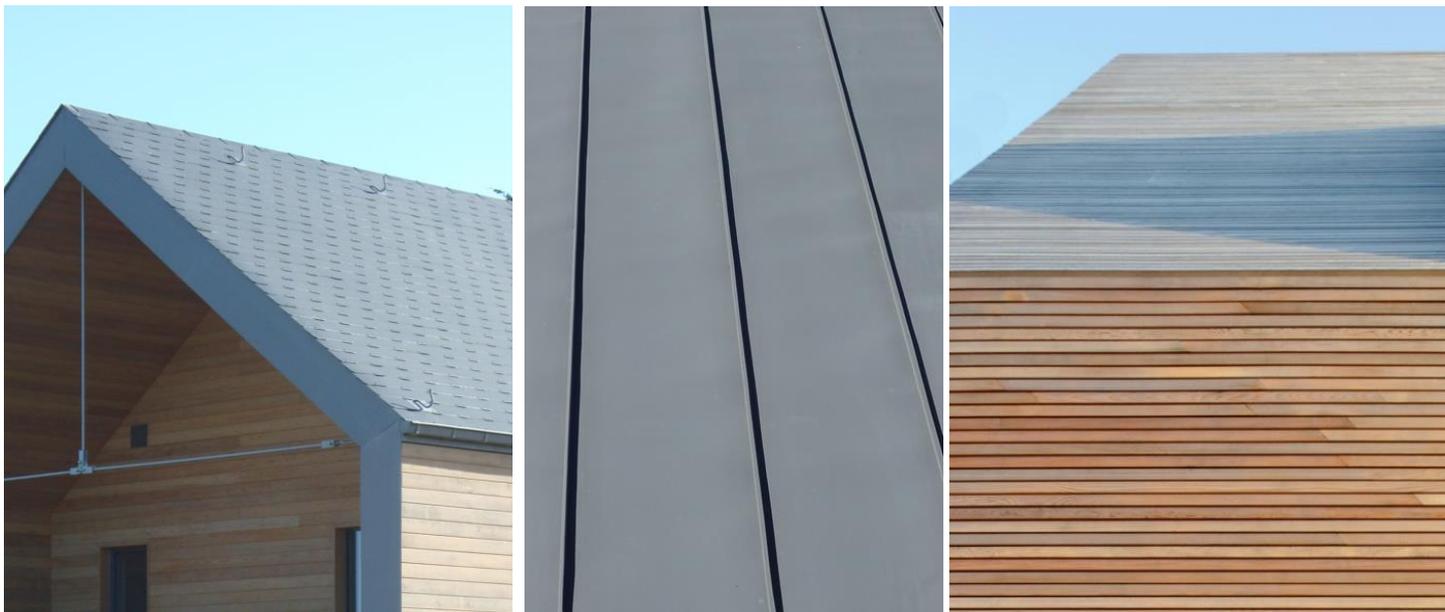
exemples du traitement des toitures inclinées
